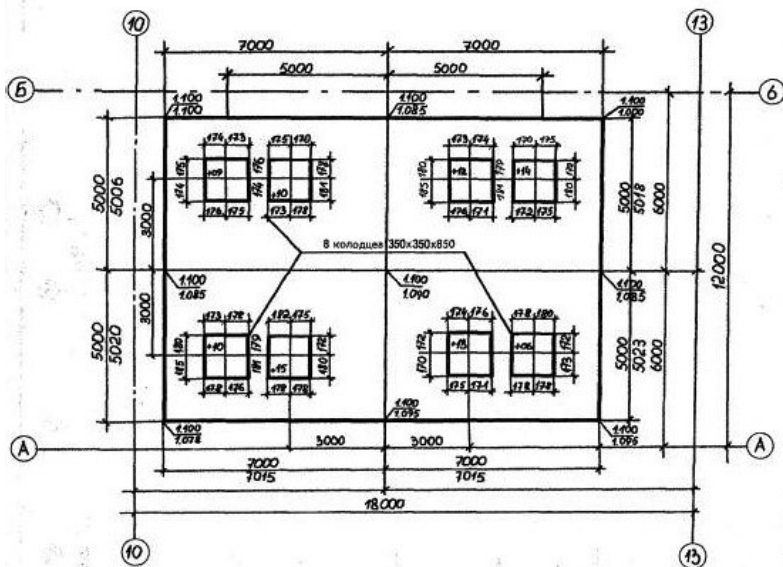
Пример исполнительной схемы фундаментов под оборудование
